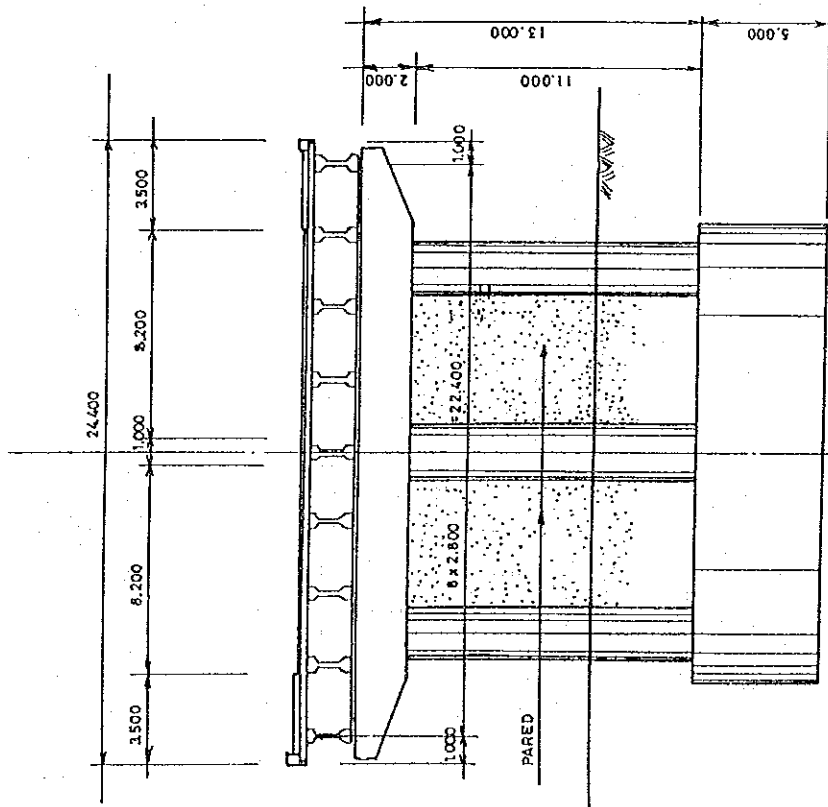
Puente de Vigas Simplemente Apoyadas,
